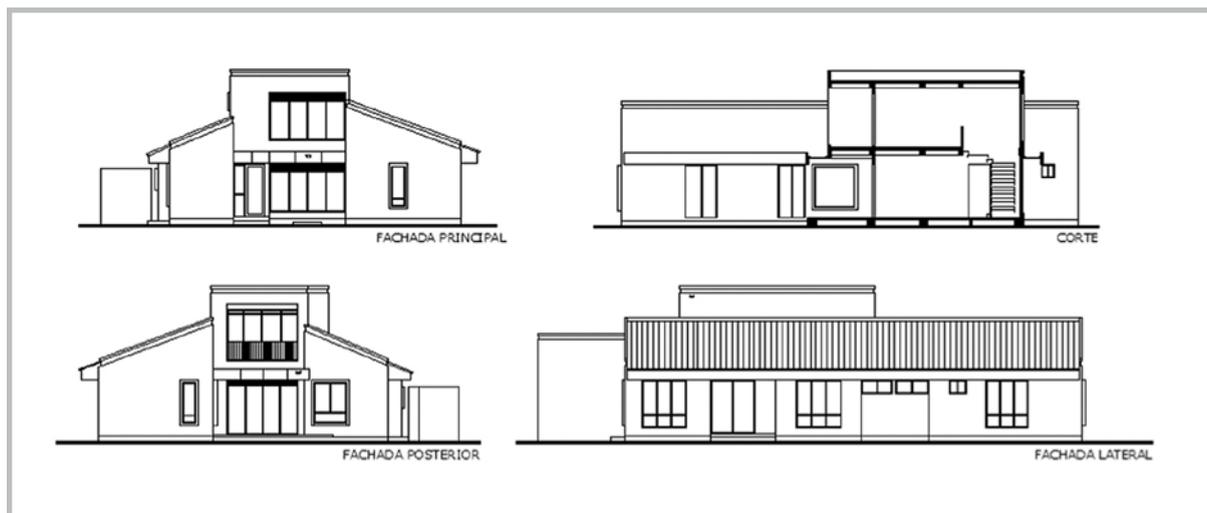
Fachadas y corte “Club del Campo la Morada”. Fuente: Planos Nuevo Urbanismo (2010)
